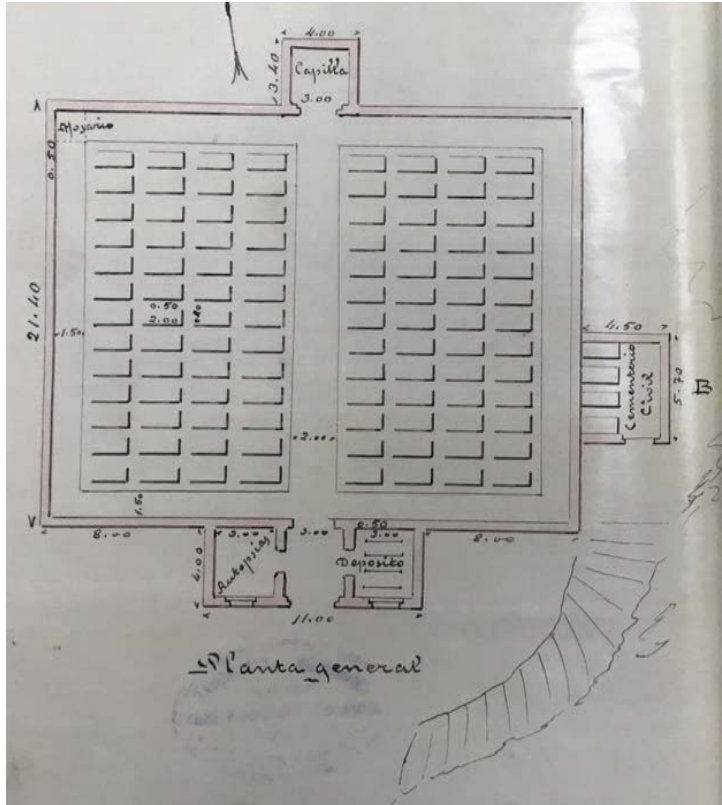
Plano del cementerio de Villamalur realizado por José Gimeno. Imagen de la autora.
